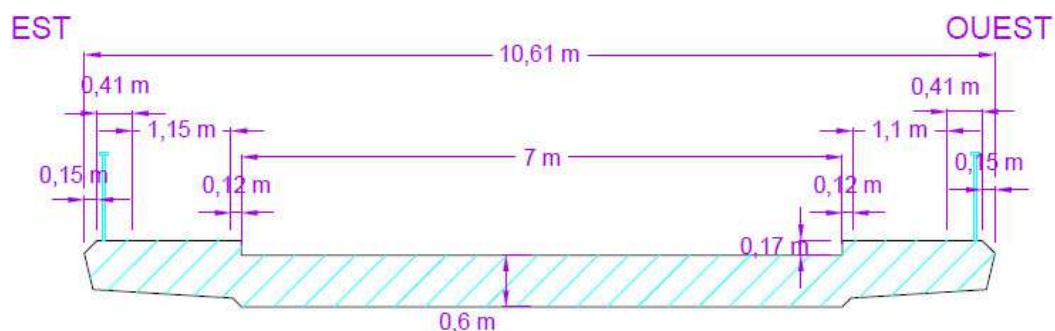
OA RN10 – Coupe transversale schématique de l'ouvrage existant – source IDP de 2018
